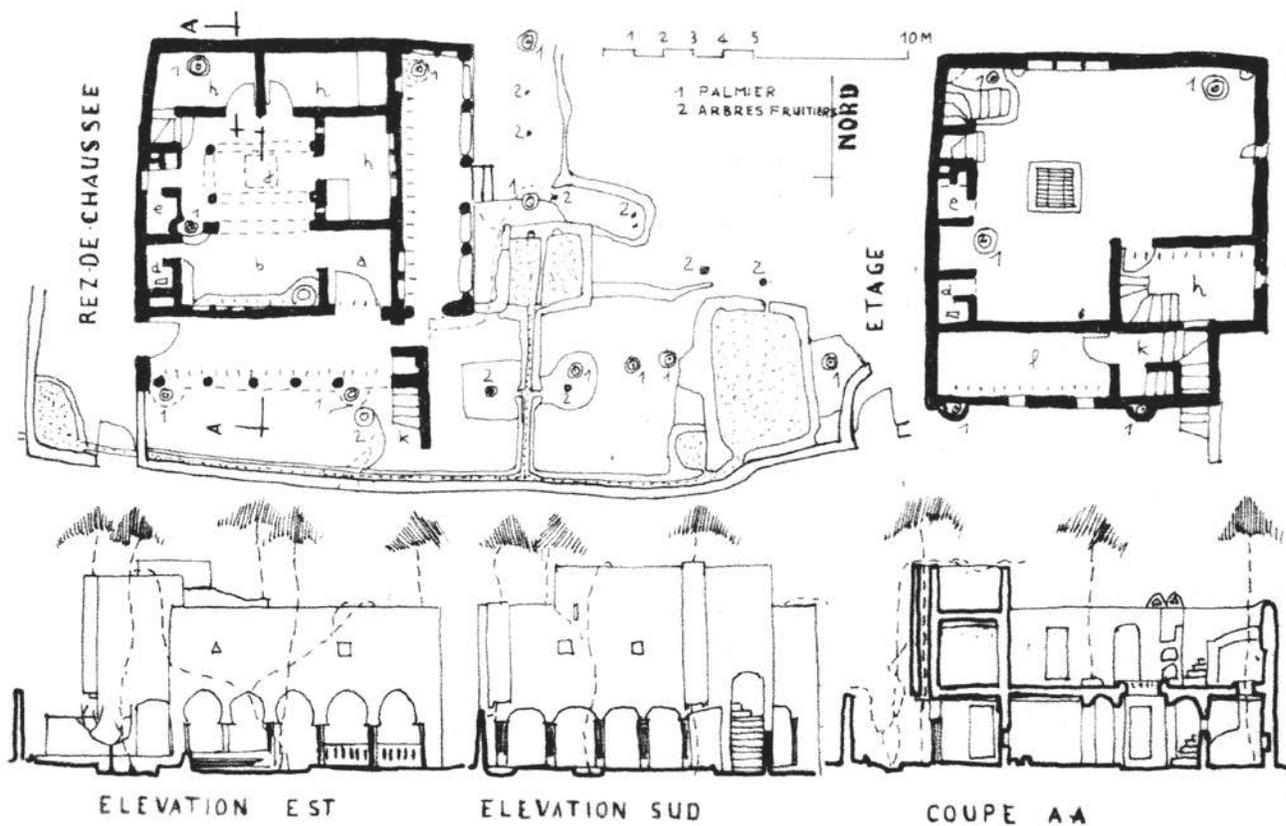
Planta, elevaciones y corte de una vivienda en el palmar de Beni-Isguen
